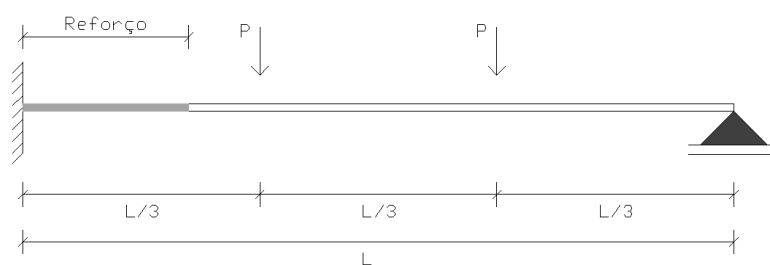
Esquema de ensaio de flexão simples – Ensaio 5.
